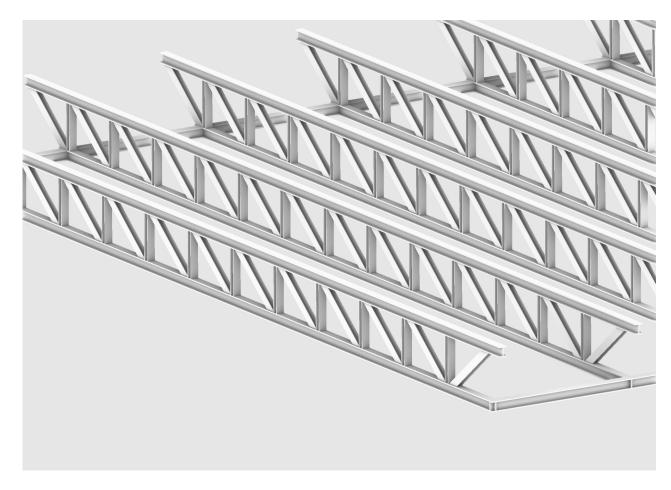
Fachwerkträger-räumliches Fachwerk
